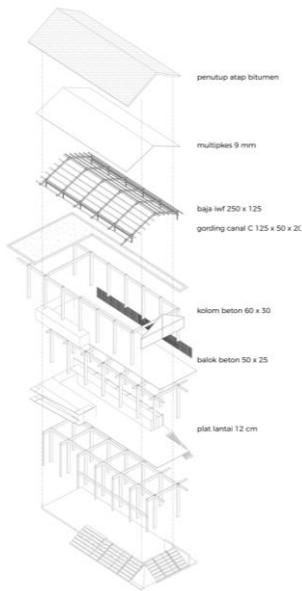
16. Elemen struktur massa Pembudidayaan
